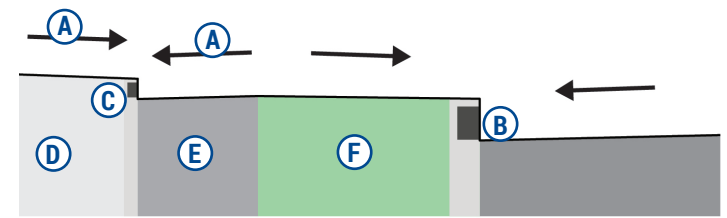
Exemple 2 de la vue en coupe de l'élévation : drainage orienté en direction du puisard complémentaire
